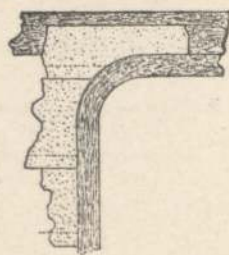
Grundlage eines Treppen-Austrittsknotens mit Viertelskropfstück und durchlaufendem Austritt.
